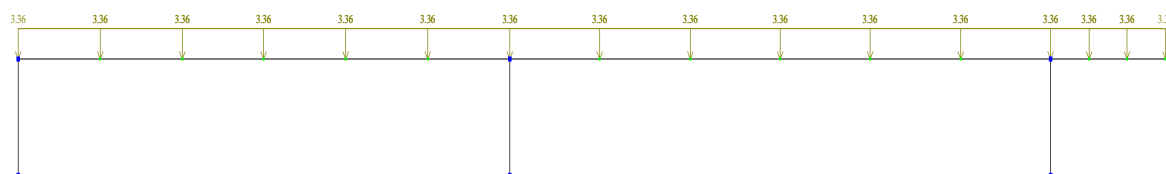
Постоянная нагрузка от плит перекрытия и состава пола
